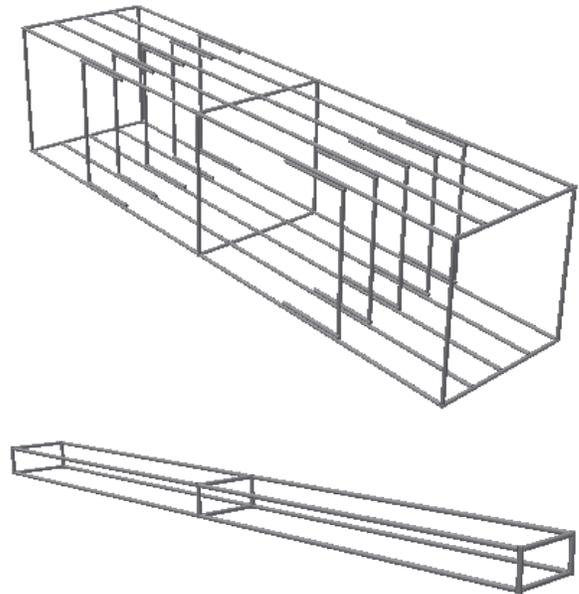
y 25: Refuerzo de pilares. Fierro 16 mm. Modelo de elaboración propia.
